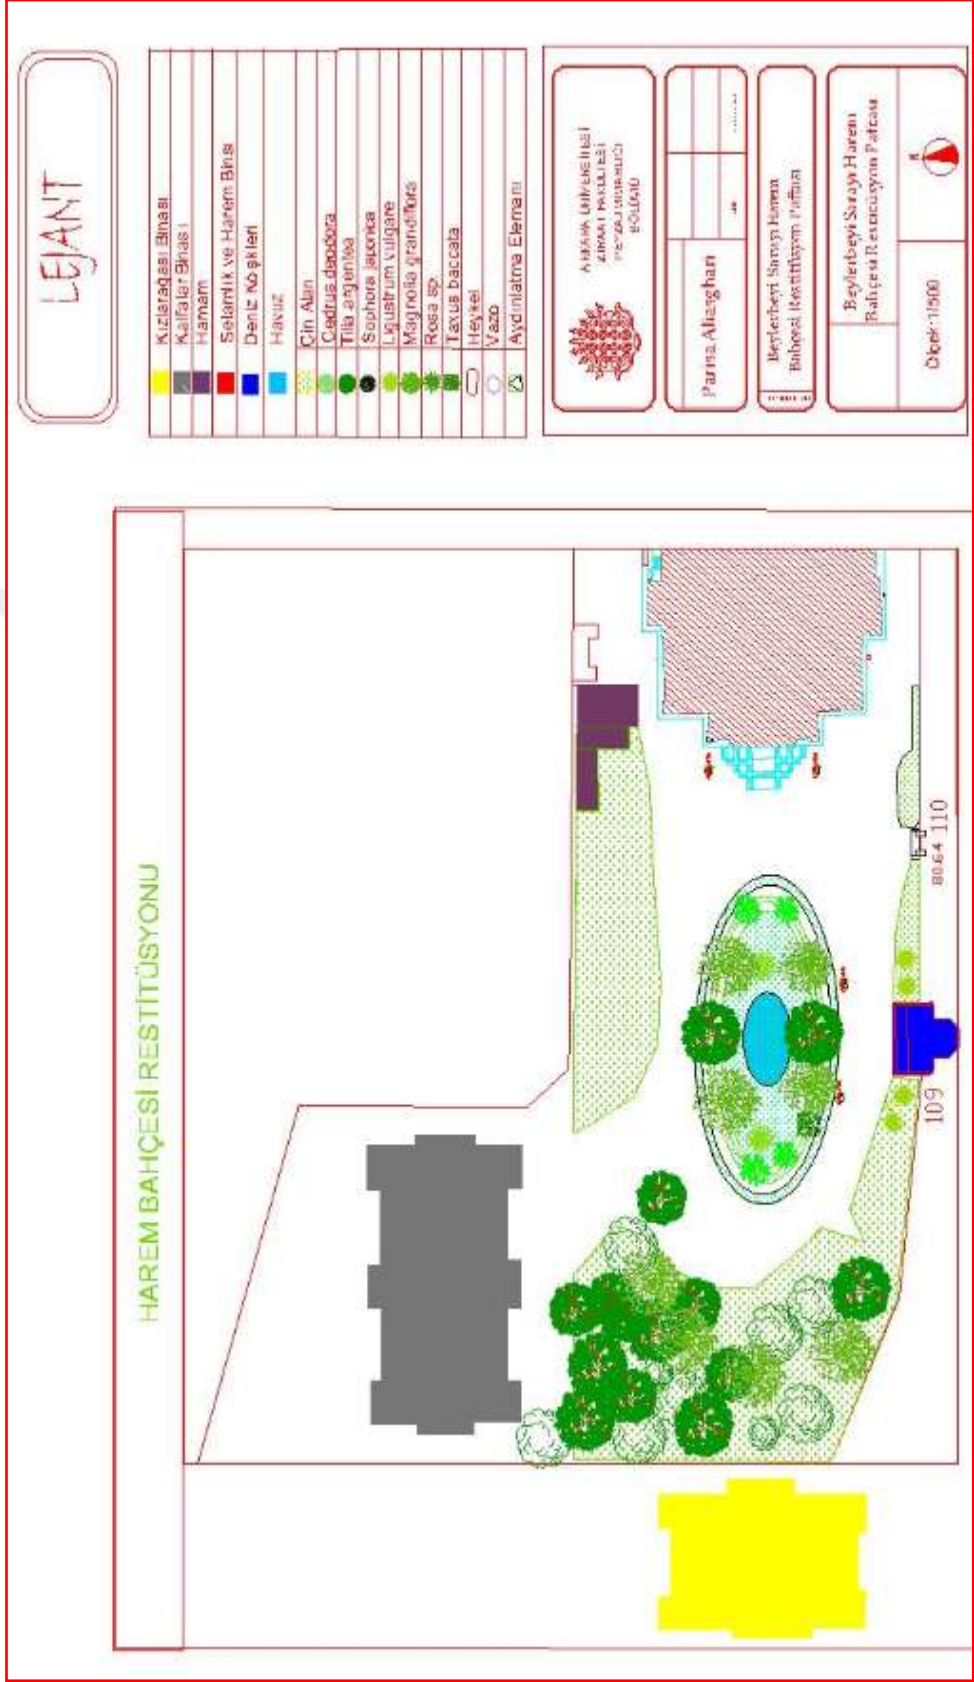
Harem Bahçesi, mevcut yerleşim planı (Orjinal 2016)
